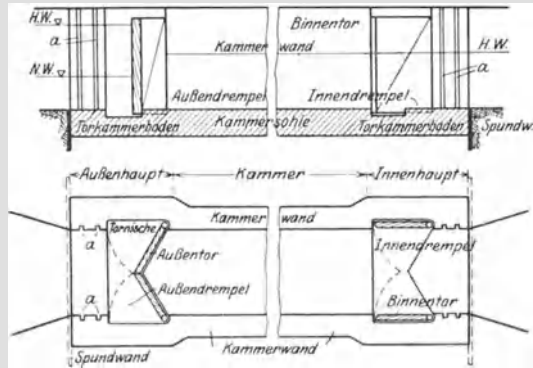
a u. b. Einfach kehrende Seeschleuse.
